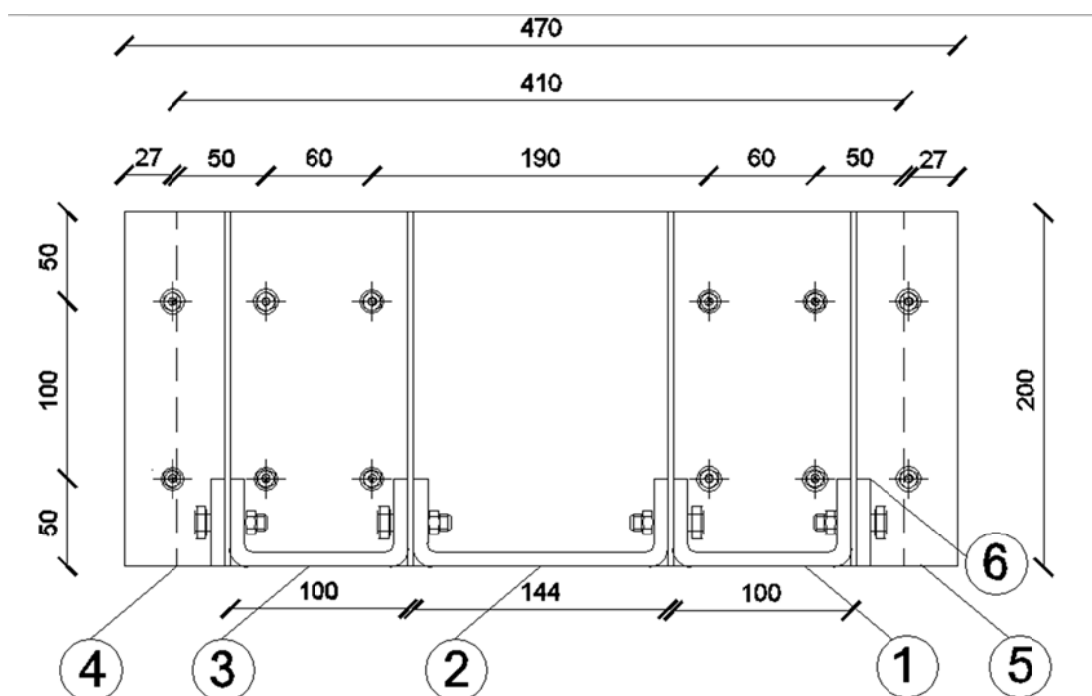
Vista in pianta dei sistemi di accoppiamento
